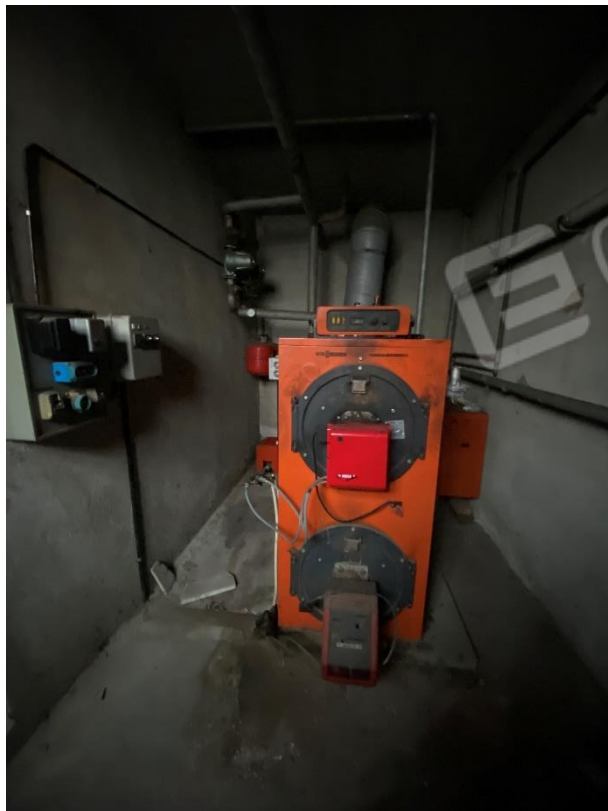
VISTA INTERNA CENTRALE TERMICA PIANO SEMINTERRATO
